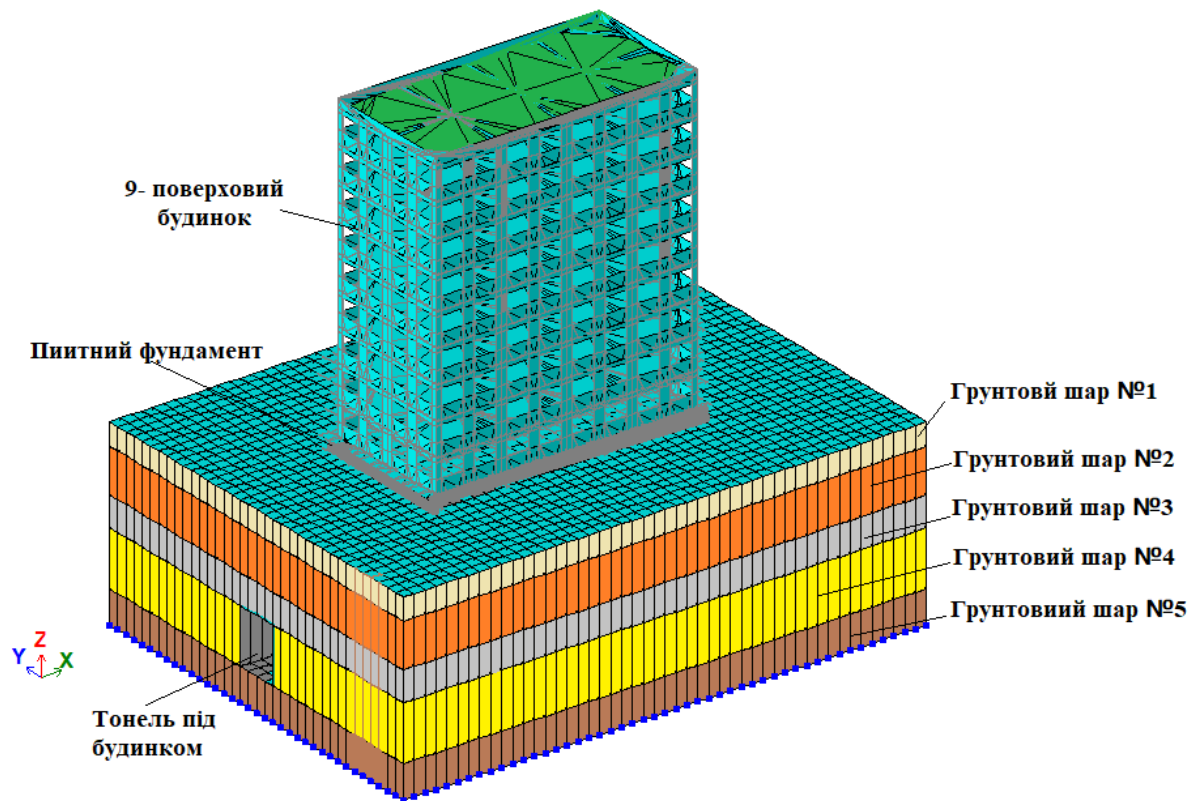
Скінчено-елементна модель геотехнічної системи «основа з колектором – плитний фундамент – надфундаментна будівля (9 – поверховий дім каркасного типу)»
